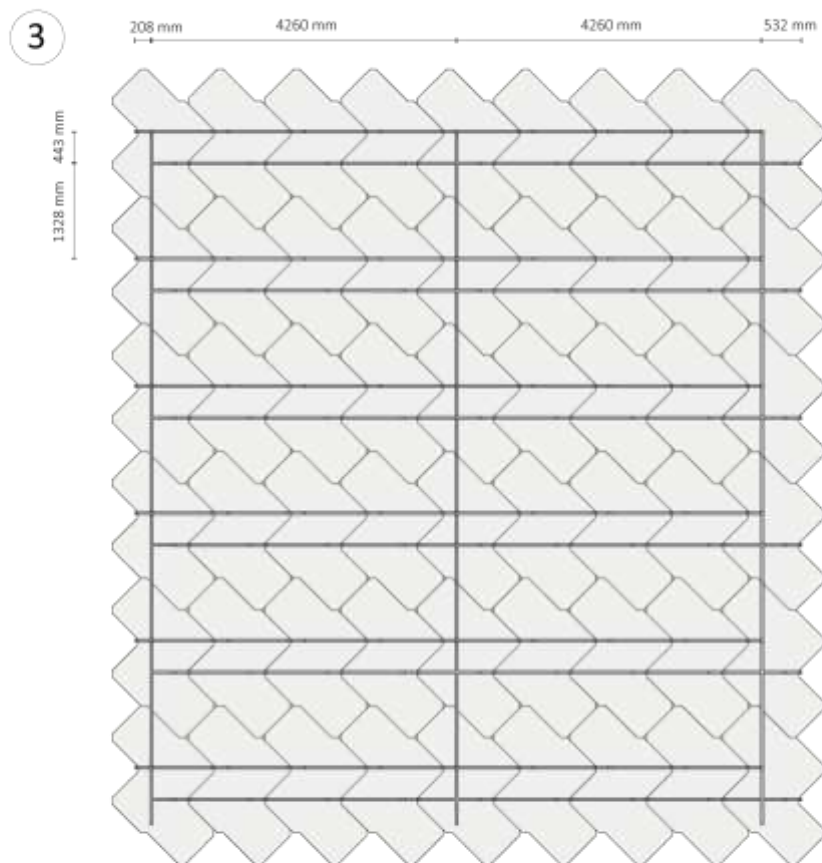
3_ Estructura secundaria sobre fachada propuesta.
